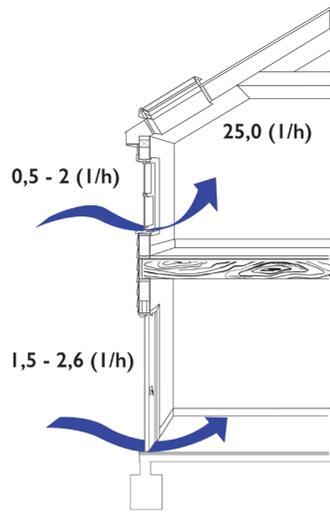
Infiltración de aire en ventanas y puertas en viviendas de madera.
